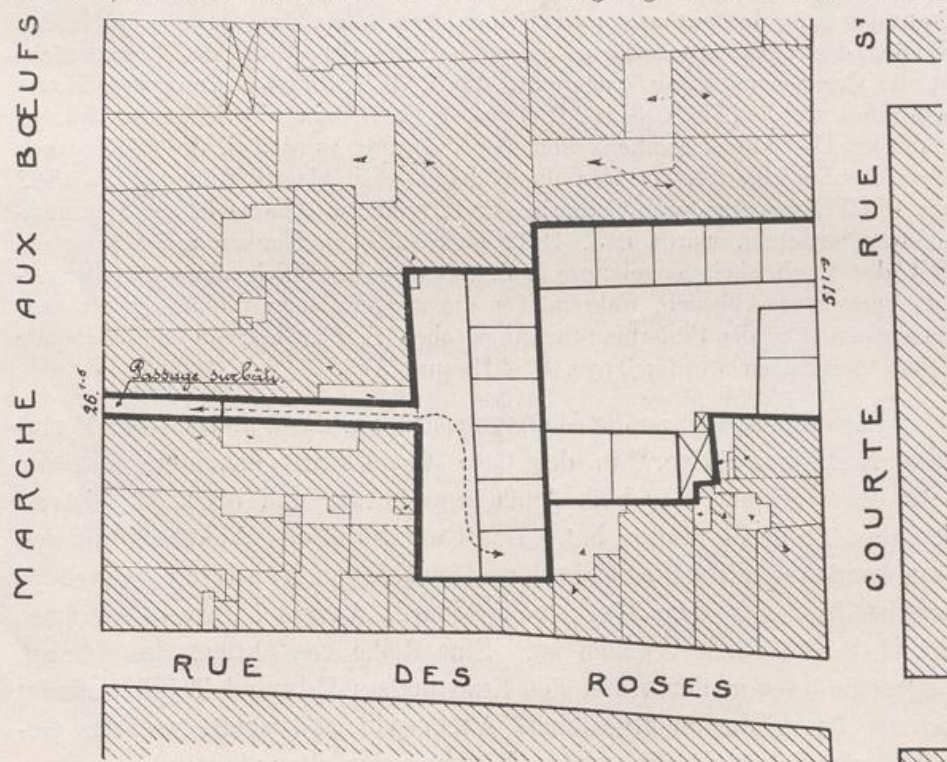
Stiftungen Franciscushof und van Dale, Grundriß. Maßstab 1 : 650.
